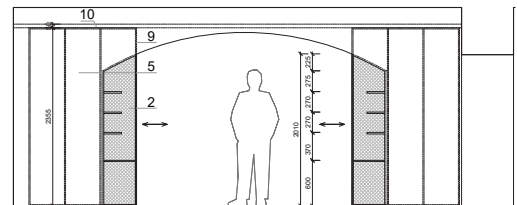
DETAIL C - KONSTRUKCE S LED OSVĚTLENÍM 1:5
